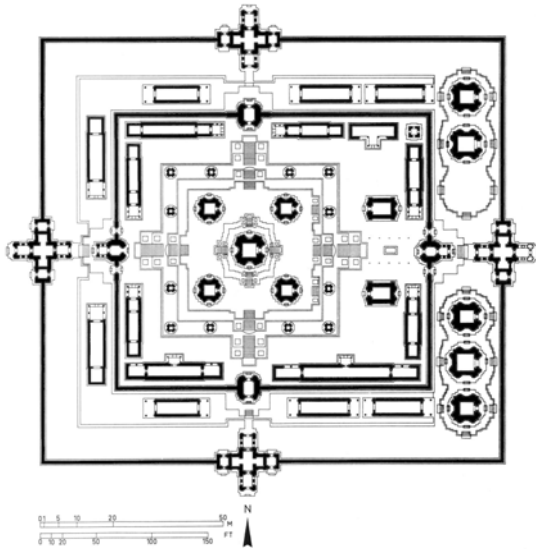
Grundriss Pre Rup/Angkor
